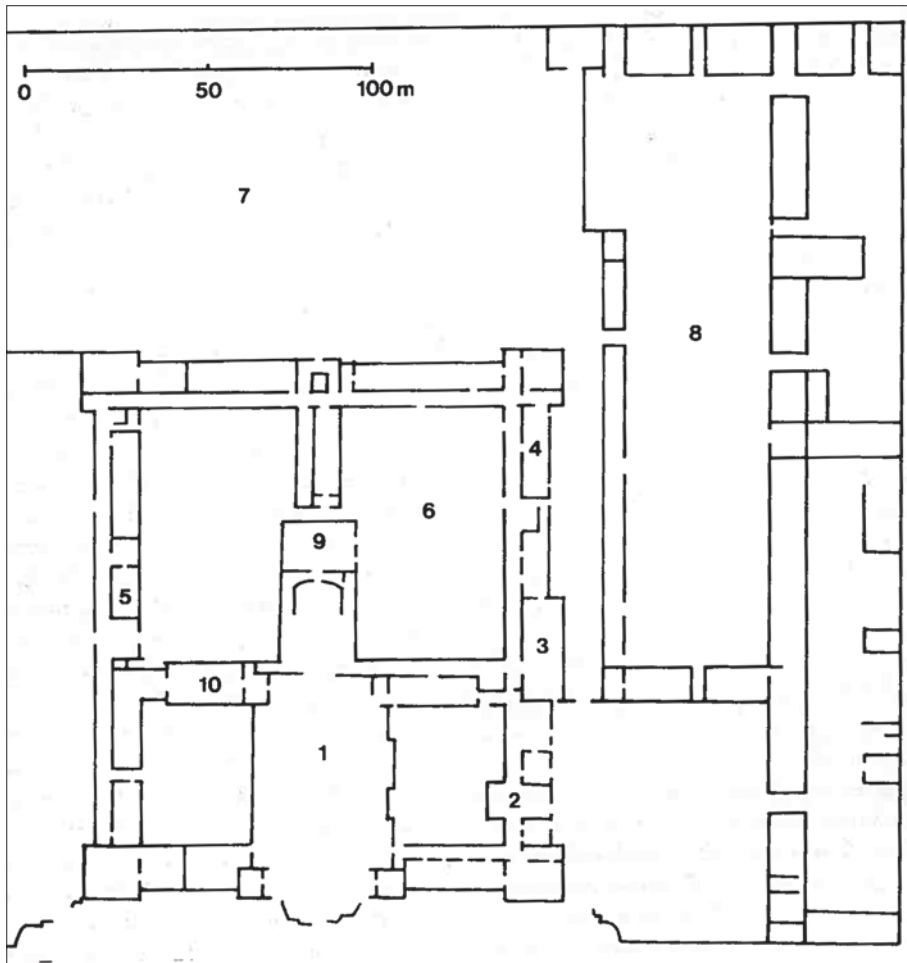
Planschema des Barockbaus Kloster Einsiedeln, nach Kuhn
